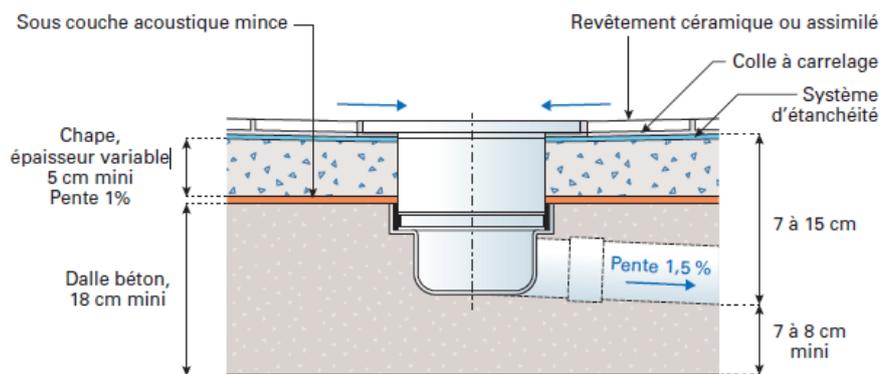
Réervations nécessaires – exemple avec un revêtement céramique ou assimilé
